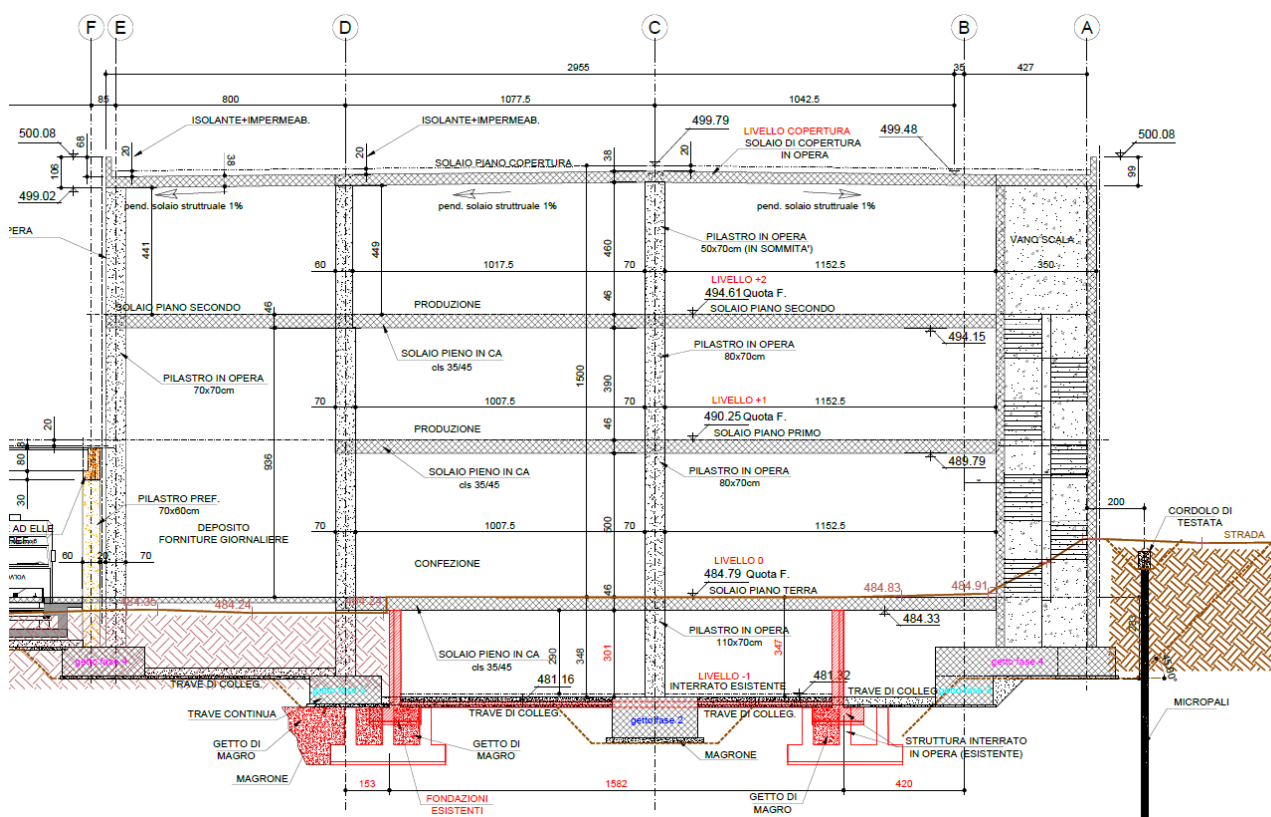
Sezione trasversale C-C – Fabbricato Ex. Piemonte
